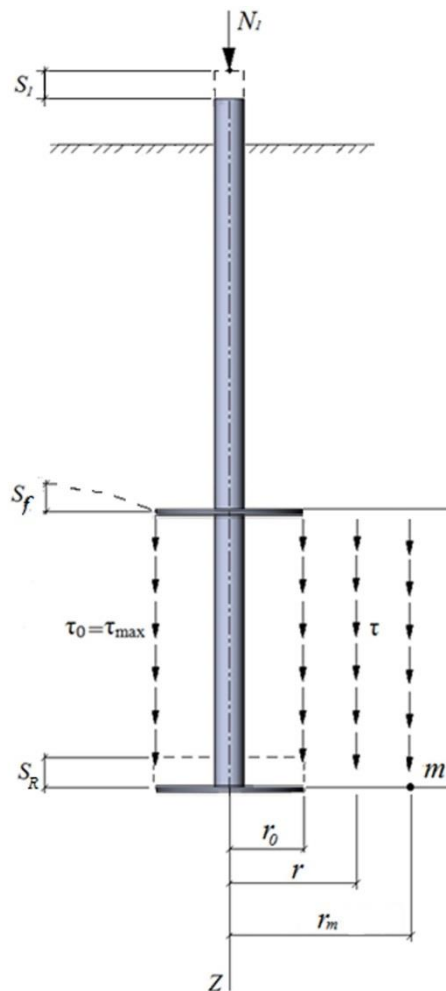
Расчетная схема к определению осадки винтовой двухлопастной сваи  $S_I$  на первом этапе нагружения:
